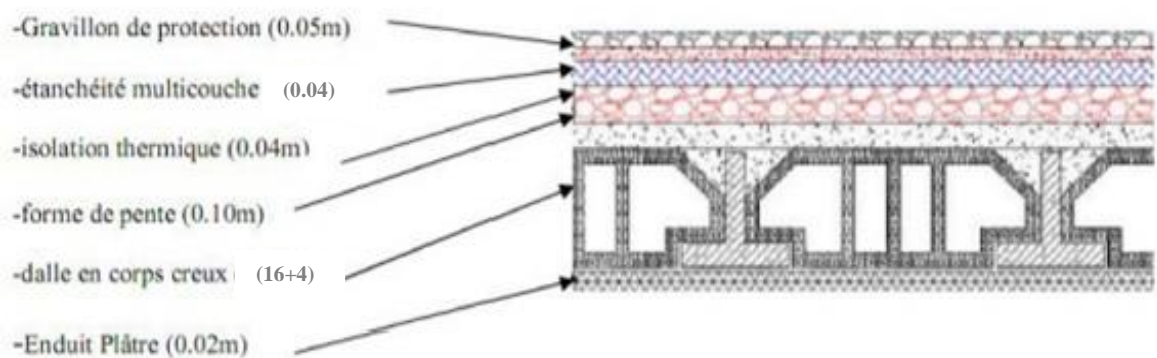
Détail des constituants du plancher terrasse inaccessible
